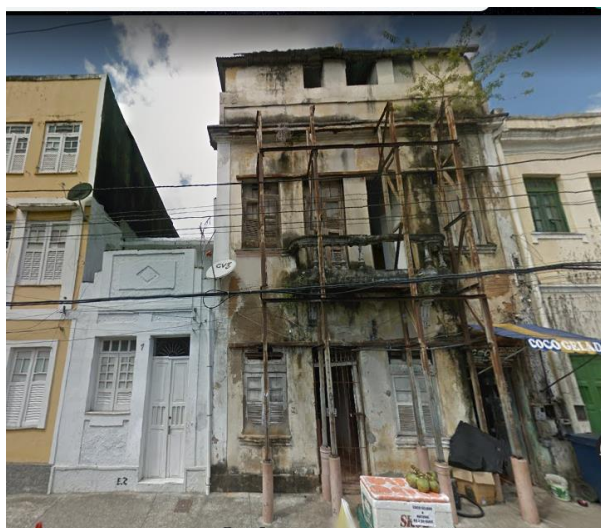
Rua dos Adobes nº 7 e 5 | FONTE: Google street view
